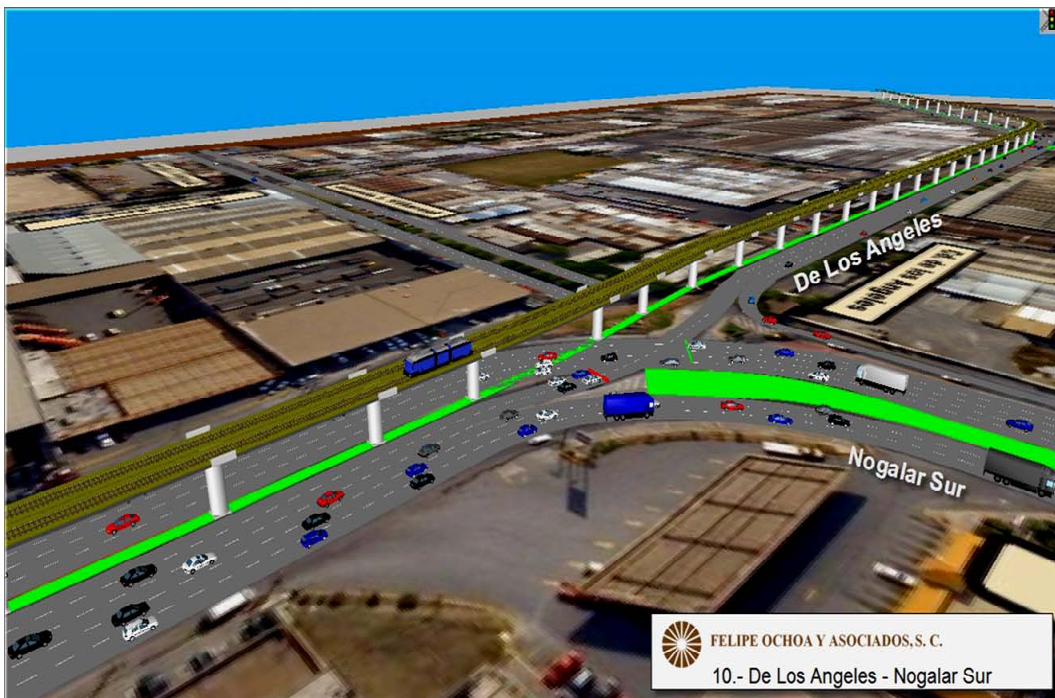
Vista elevada hacia el Oriente, de la Propuesta de Solución y Adecuación Geométrica para la Intersección de la Av. Rómulo Garza - Av. Nogalar Sur - Av. Los Ángeles.
